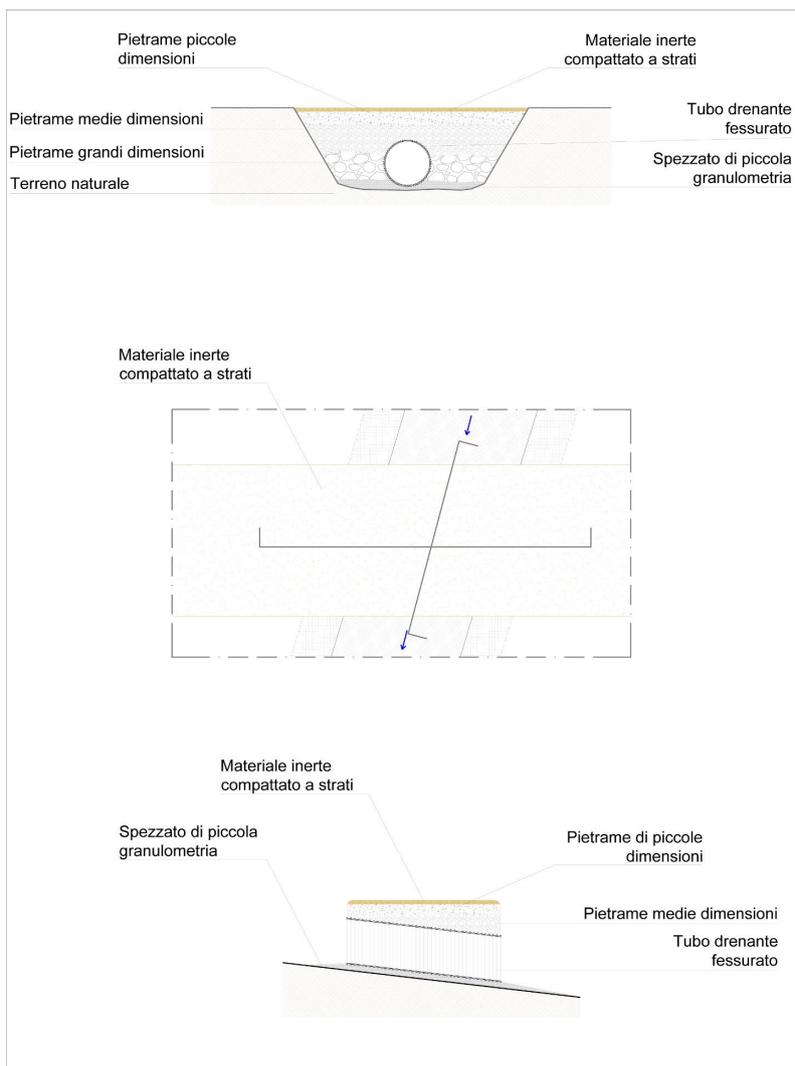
Particolare delle opere di attraversamento dell'impianto
